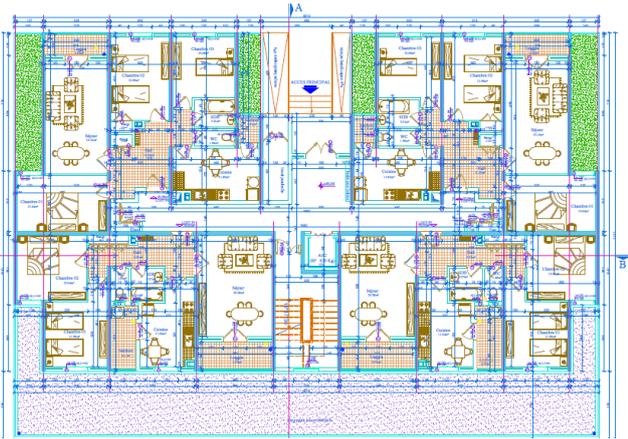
Plan de RDC, Bloc 07 / Echelle : 1/100
